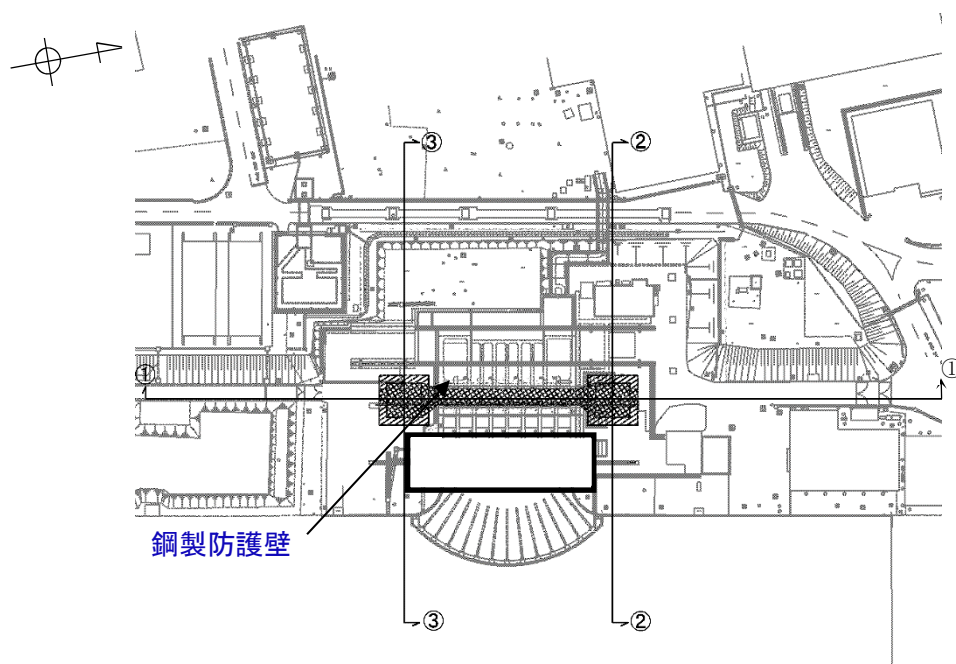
(1) 防潮堤（鋼製防護壁）の平面図
